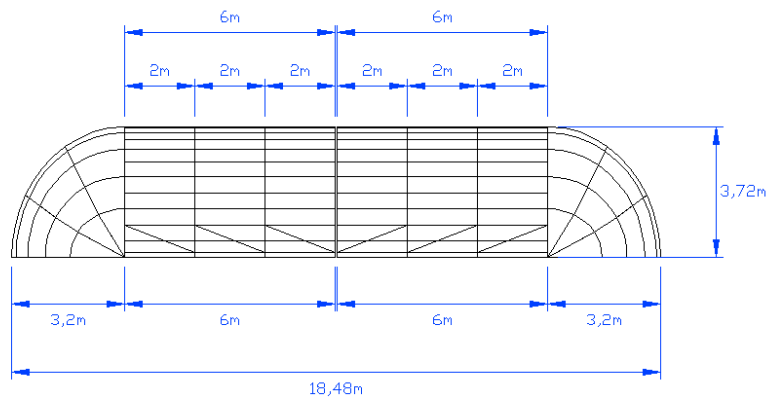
Vista Lateral de la Cubierta propuesta en la tesis.
